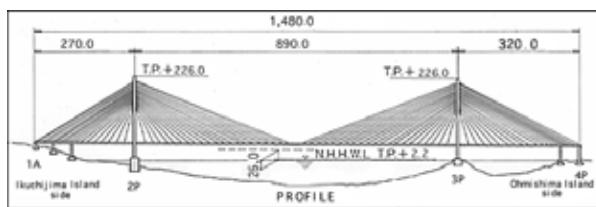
Lokacija zapadne linije Nishiseto, Japan.
